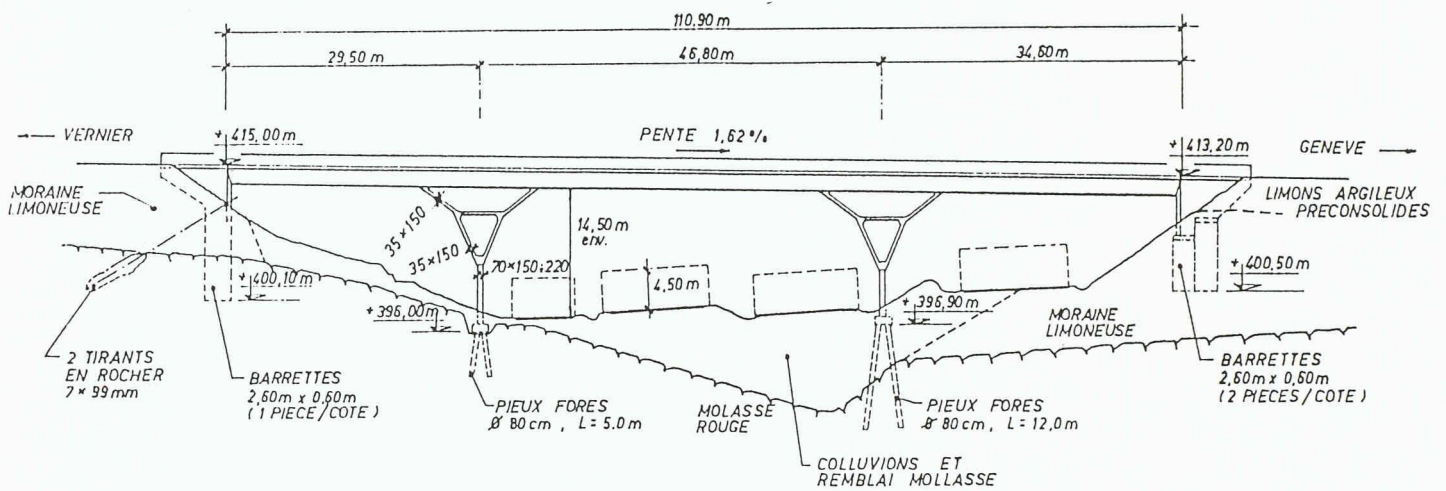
Passerelle du Bois-de-la-Grille pour deux-roues (OA 608)
